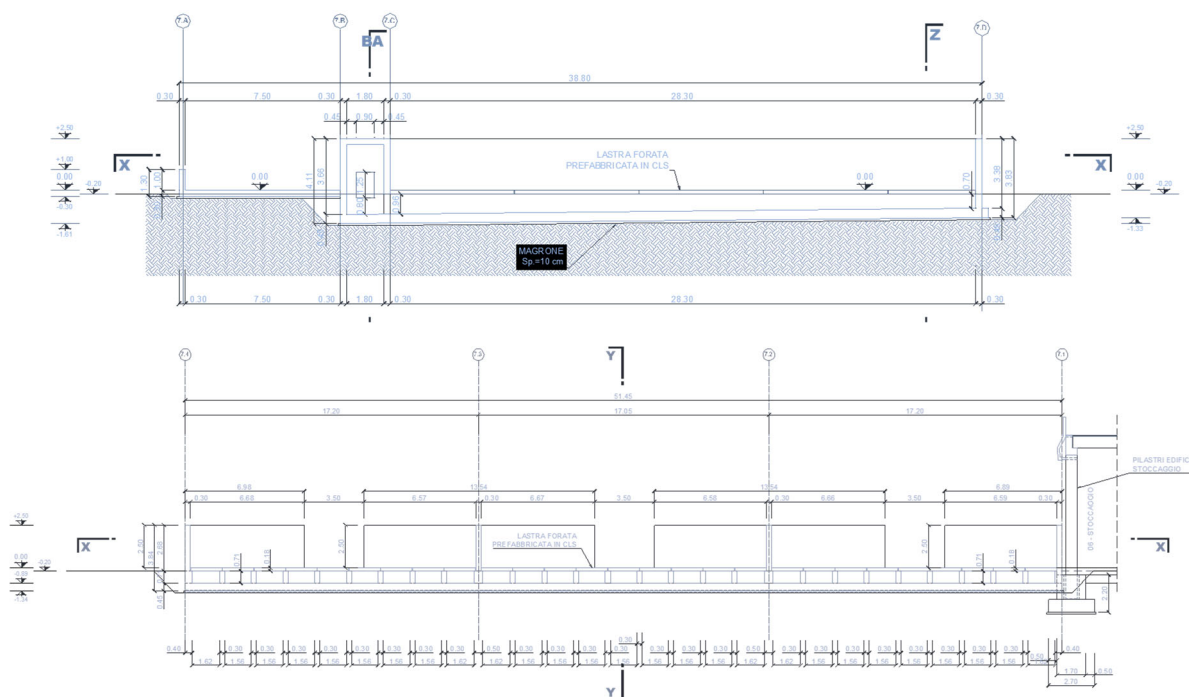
SEZIONE TRASVERSALE BIOFILTRO
